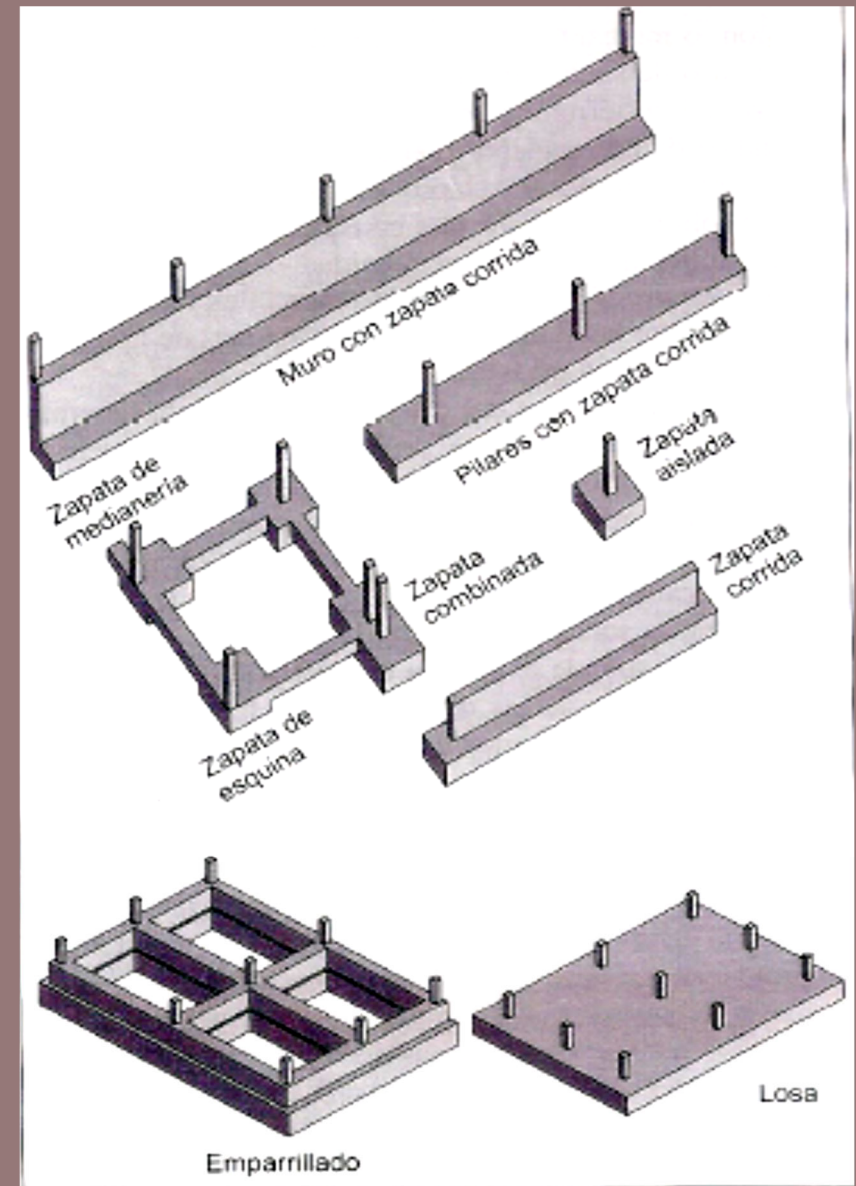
Tipos de cimentación directa (Calavera, 1987).
